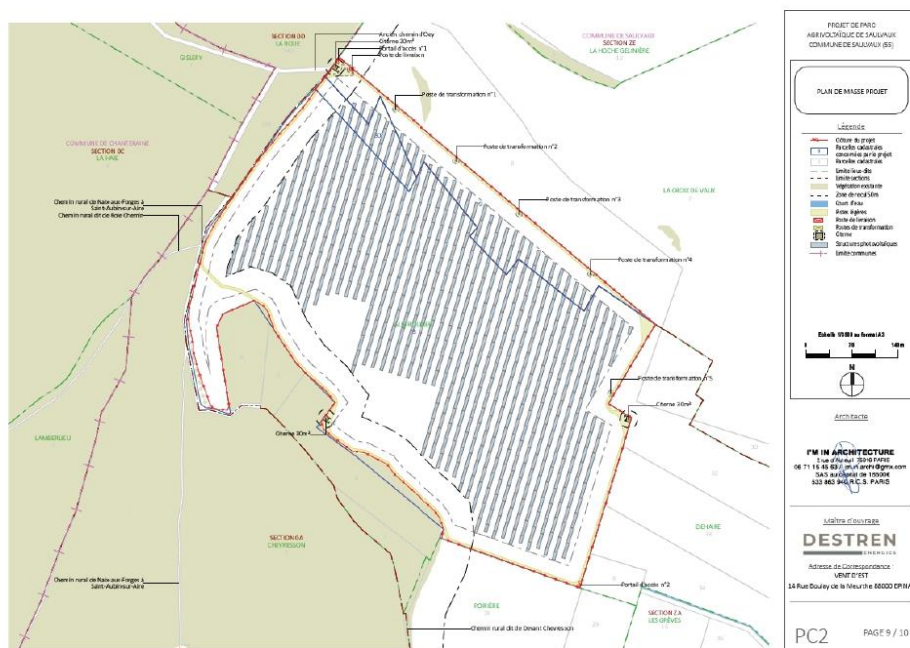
plan de masse du projet de Saulvaux (source : Destren)
